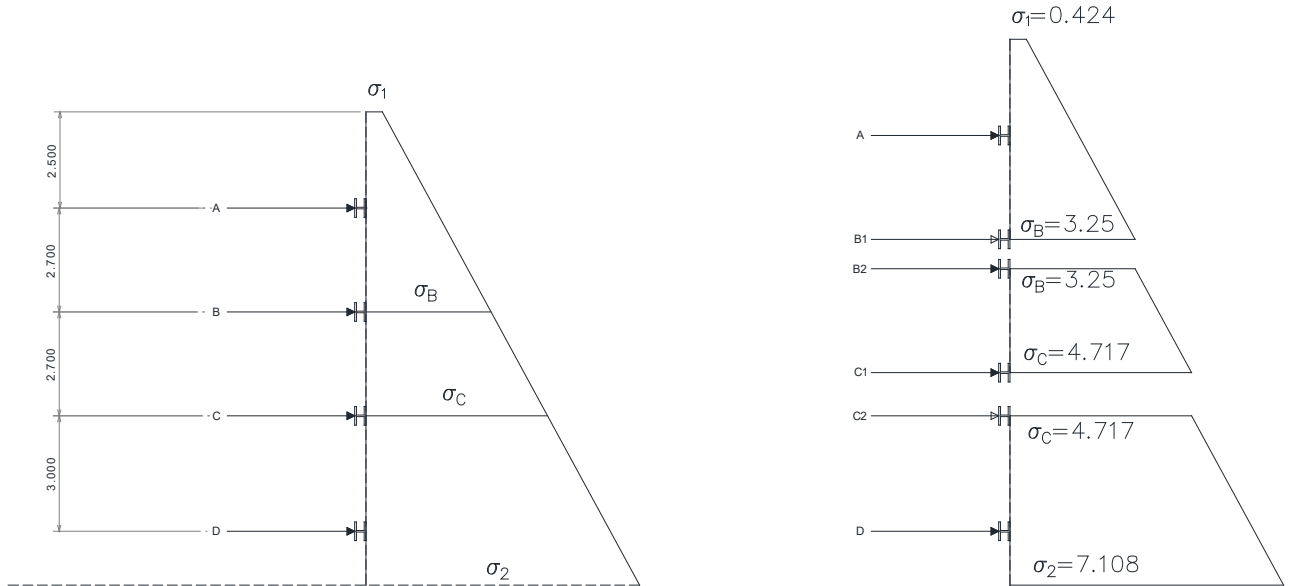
DETERMINACION DE LAS CARGAS EN LOS TROQUELES. Autoría propia.
